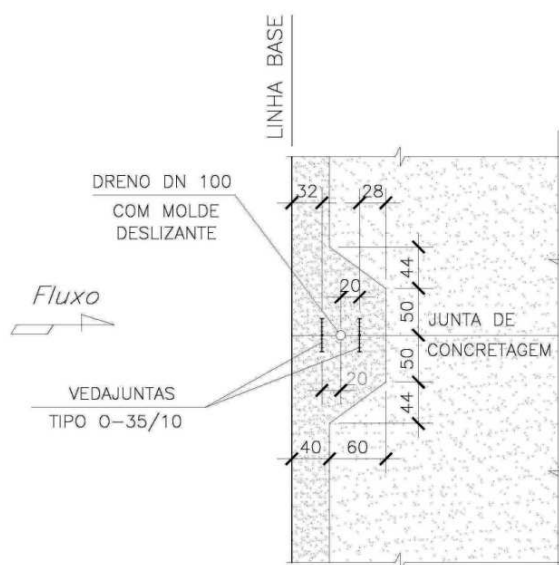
Detalhe da colocação dos vedajuntas entre as juntas de concretagem
